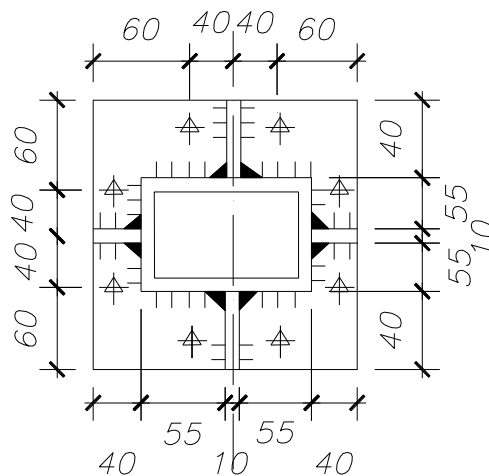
Конструктивна схема монтажного вузла нижнього поясу
